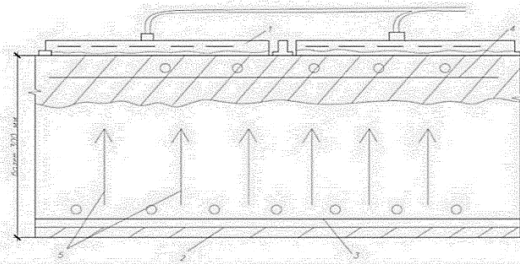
Схема электровакуумной обработки бетона в плитах толщиной более 250-300 мм: 1 – вакуум-щит; 2 – опалубка; 3 – нижняя арматура; 4 – верхняя арматура; 5 – направление движения воды в бетонной смеси под действием электроосмоса
